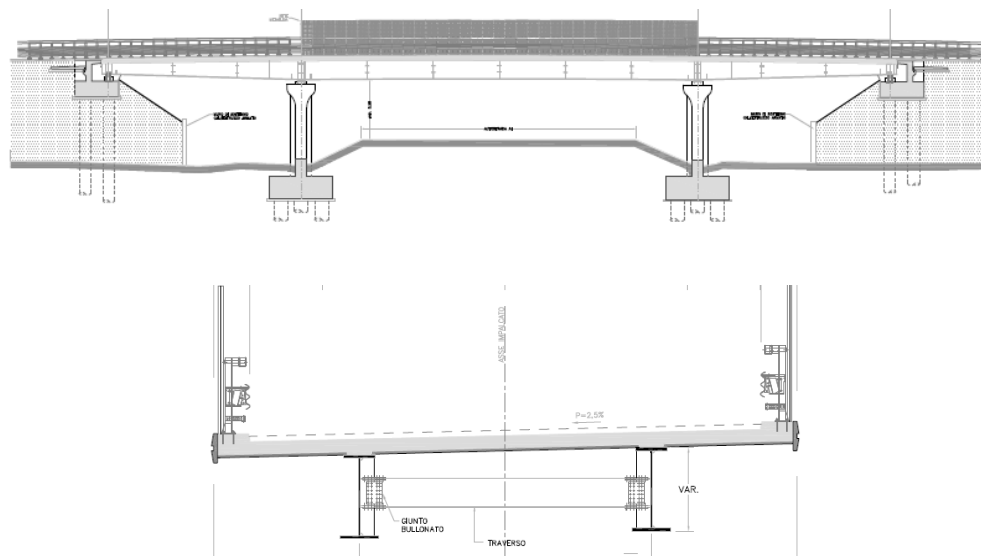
elementi tipici del cavalcavia a struttura composta con impalcato del tipo bitrave
